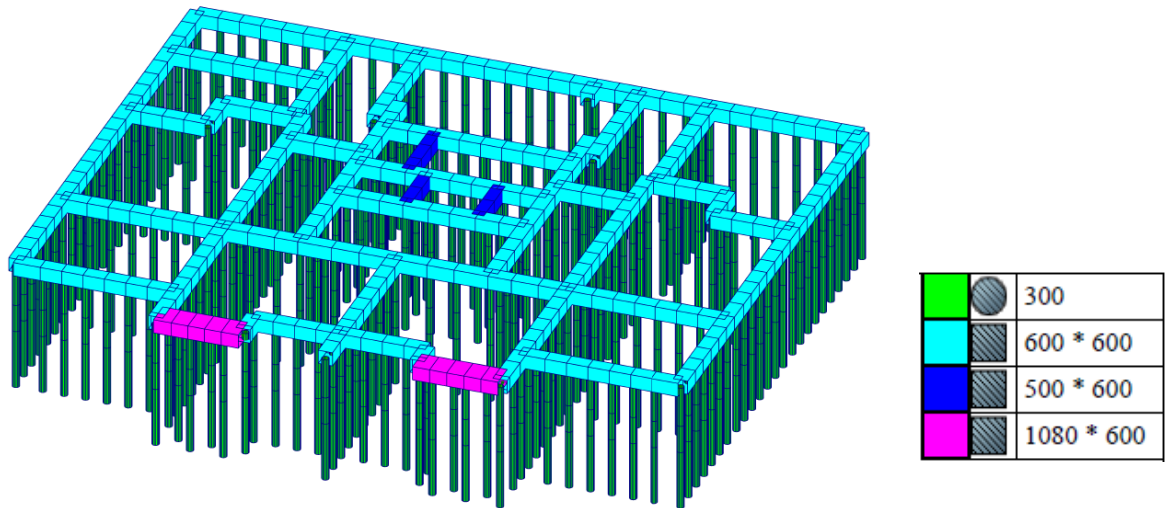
Розрахункова схема пальового фундаменту
